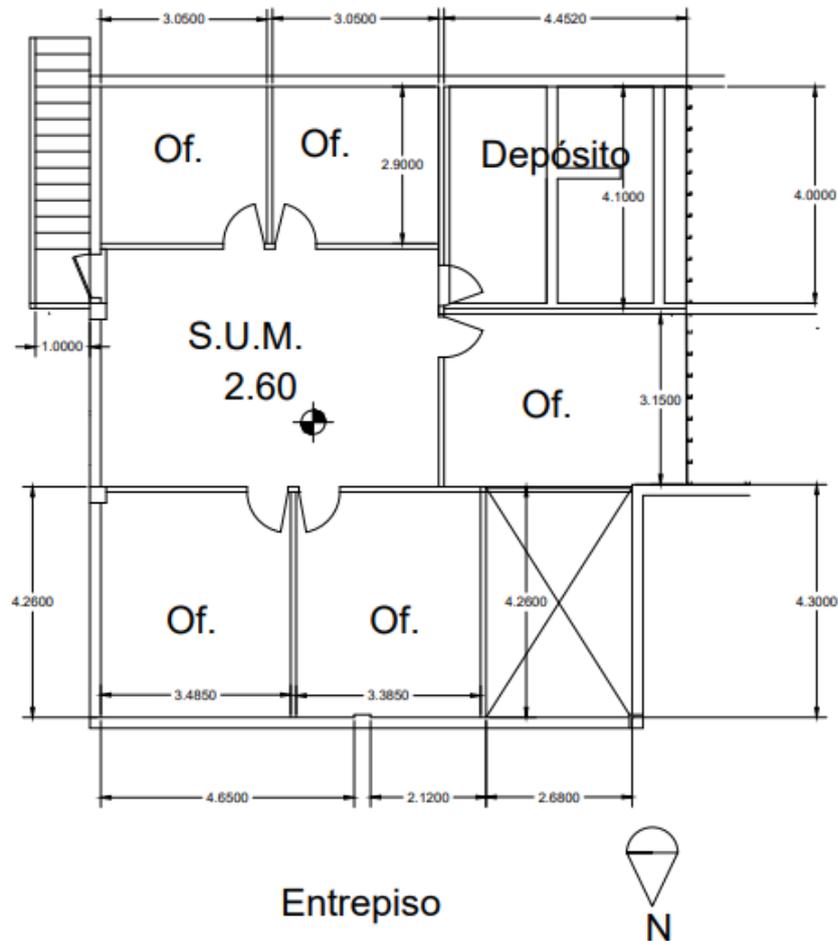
Plano del Entrepiso del proyecto. Figura tomada de los planos oficiales del proyecto
